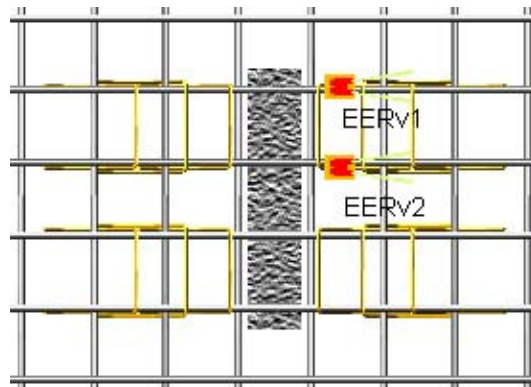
Disposição dos EERs nas armaduras de cisalhamento na laje L4
